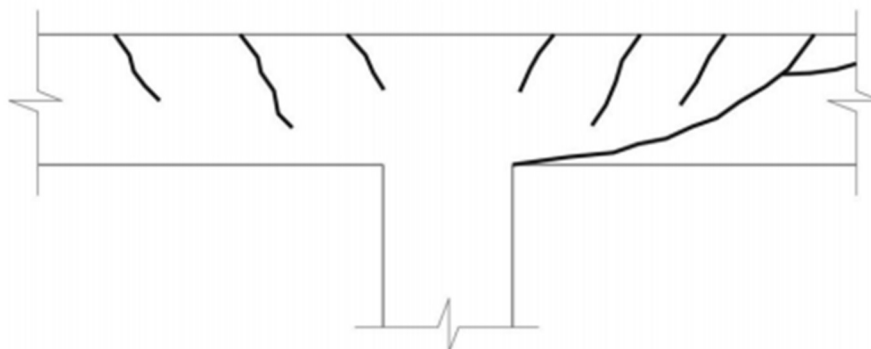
Falla de viga por cortante en proximidades al apoyo
